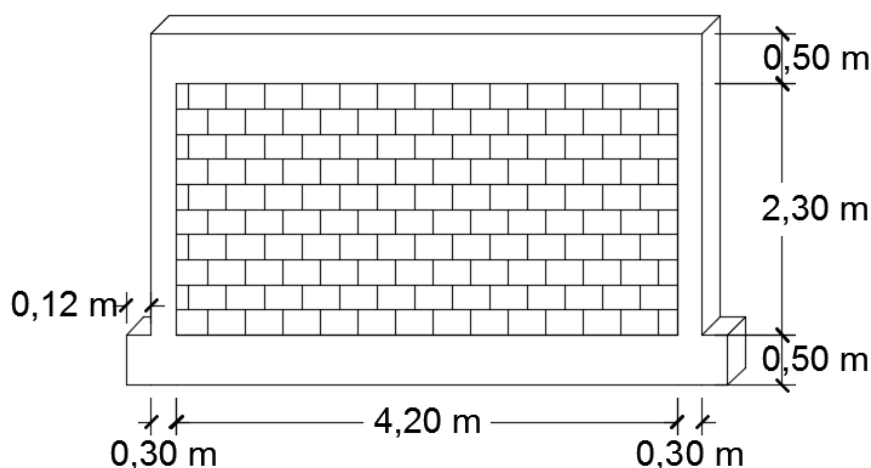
Visão geral do pórtico de betão armado para os ensaios experimentais.
